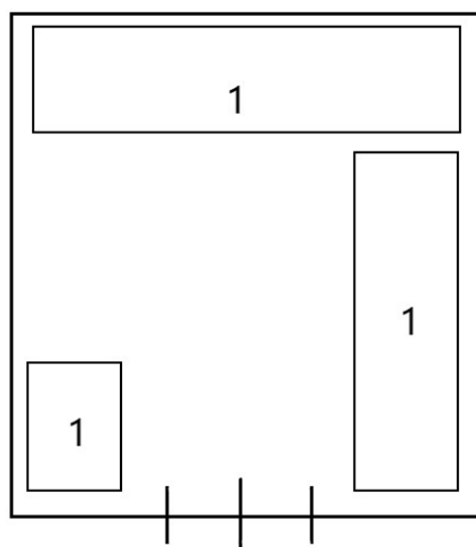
План размещения пожарной нагрузки в складском помещении №2
